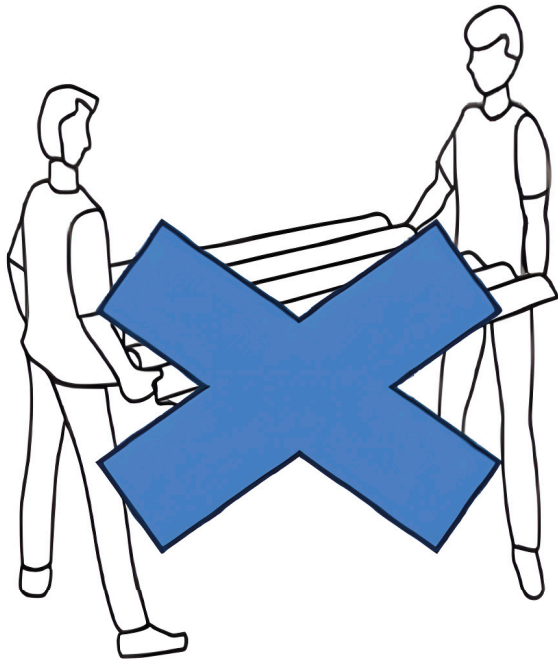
Esquema de manuseio para telhas onduladas Fonte: Adaptado de Fundação Oswaldo Cruz (2014).
